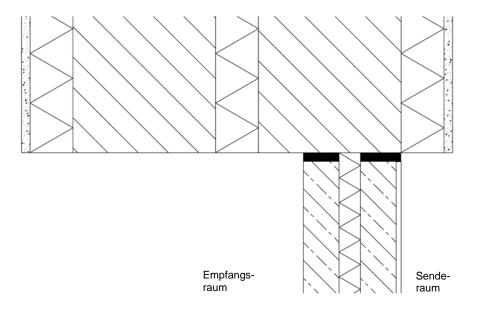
Anschlussdetail Probe 2 der Einbausituation im Prüfstand
